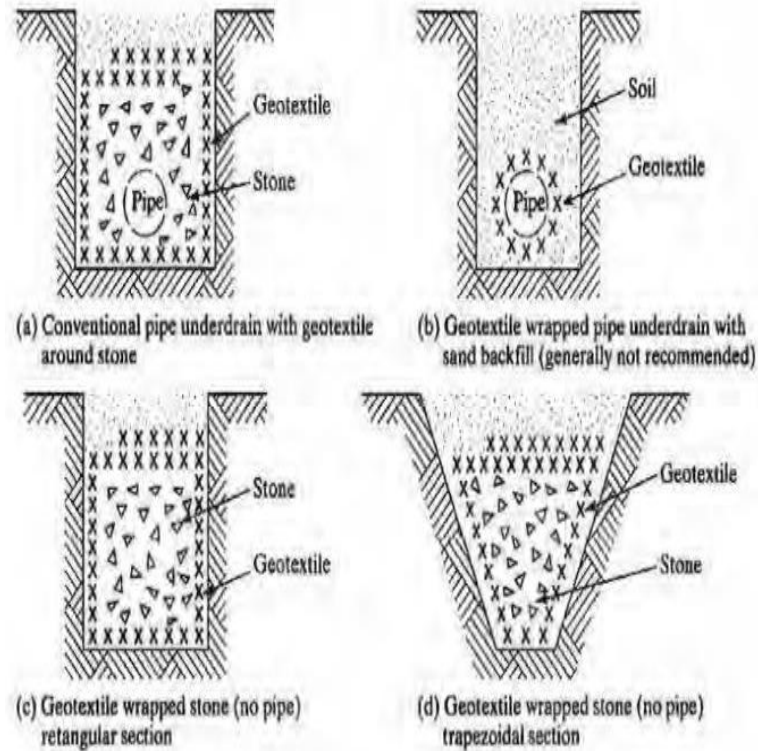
Sección típica de subdrenes con geotextil de filtración, (a) y (b) incluyen tubería de drenaje, (c) y (d) sólo tienen piedras chancadas.
